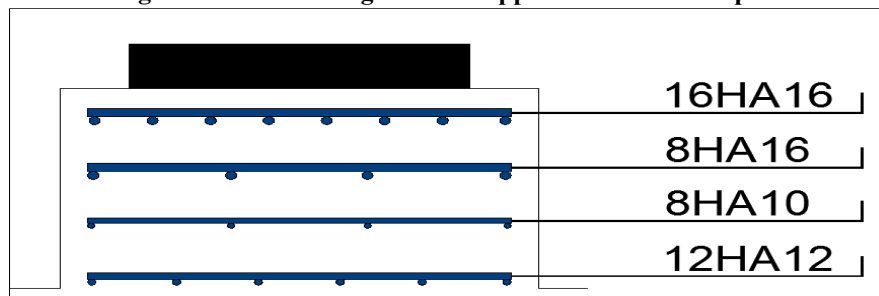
Ferrailage du dé d'appui au niveau de la culée.
